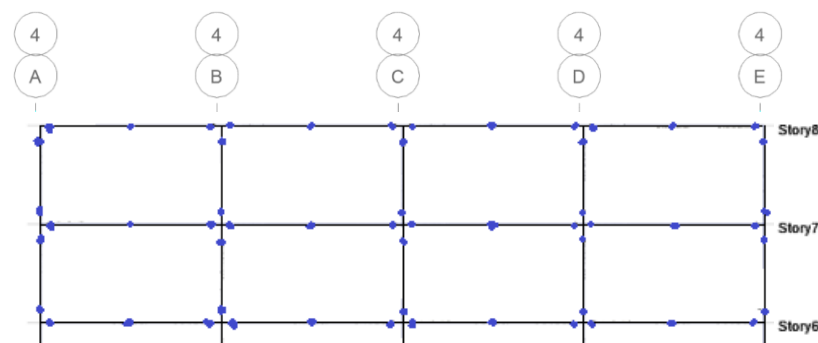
Asignación de Rótulas Plásticas en vigas y columnas
